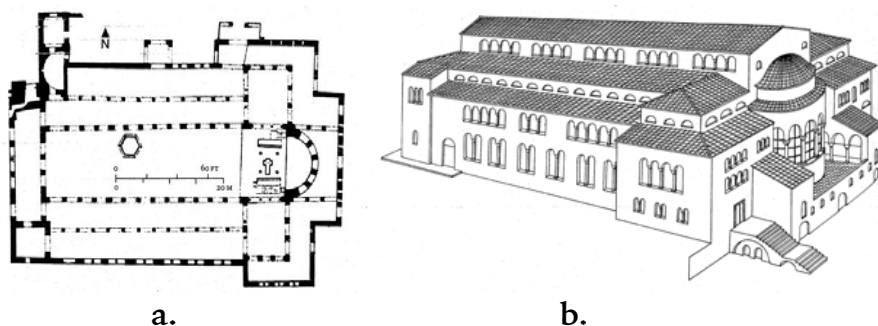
Biserica Sf. Dumitru, Thessaloniki, Grecia: a - plan reconstrucție; b- vedere izometrică.
